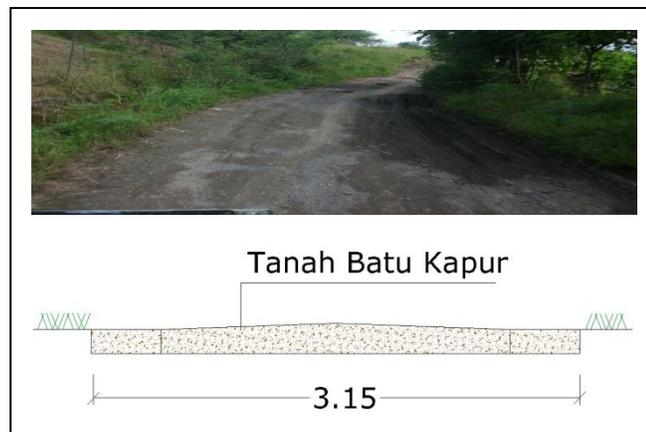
foto dan sket profil bk1 tanah batu kapur baik
